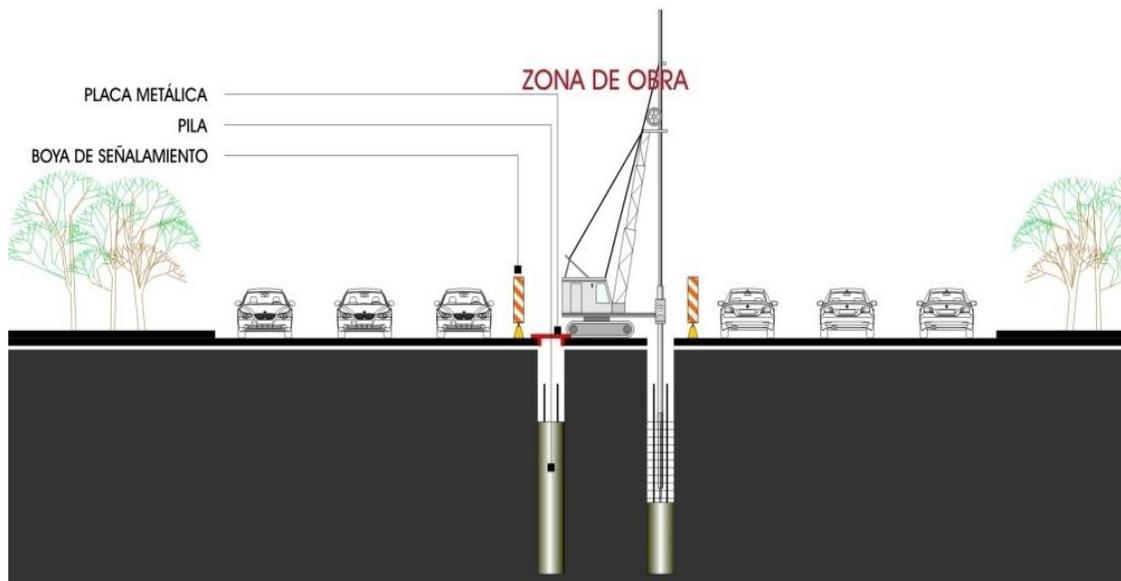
“Habilitado y armado de pilas de cimentación”
